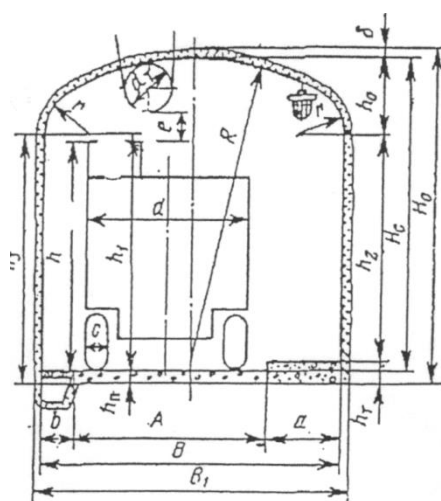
Сечение транспортной выработки прямоугольносводчатой формы при безрельсовом транспорте с набрызгбетонной крепью
